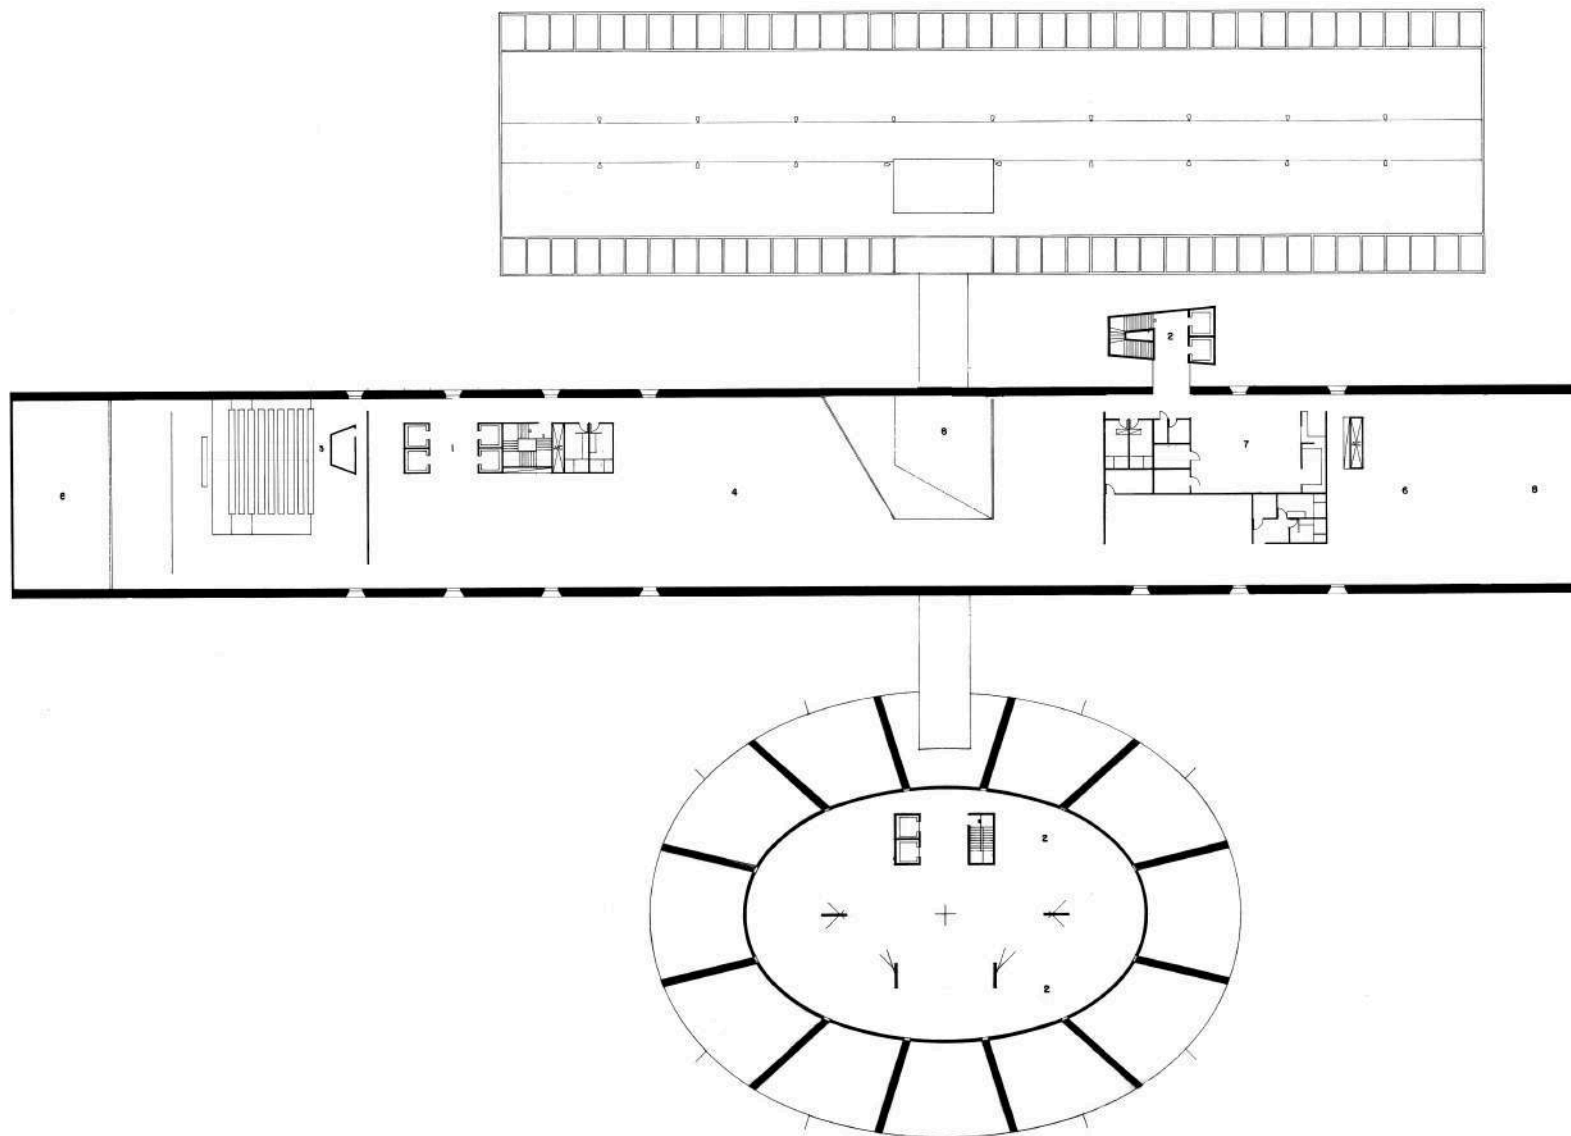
Planta do 4º pavimentos do Arquivo Público, 1992. Fonte: ArqPDF.
